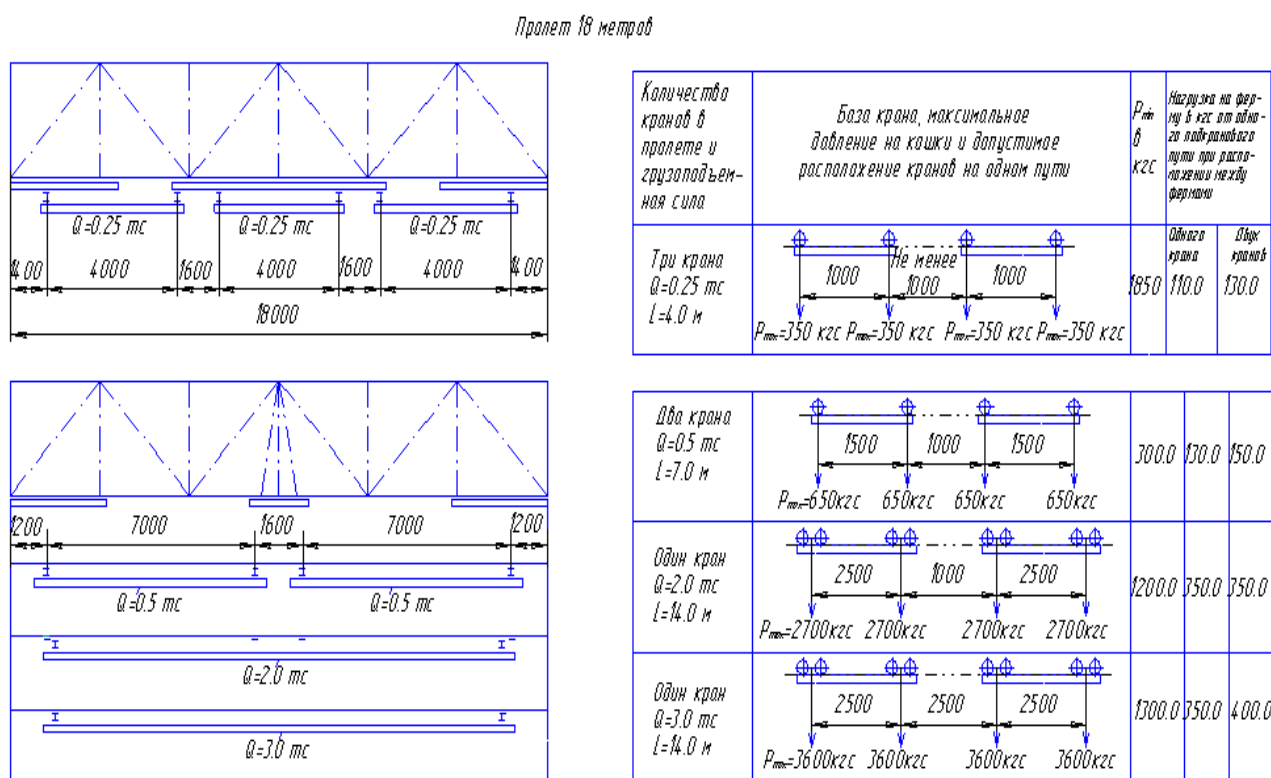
Строительное здание на подвеску кранов к несущим фермам
